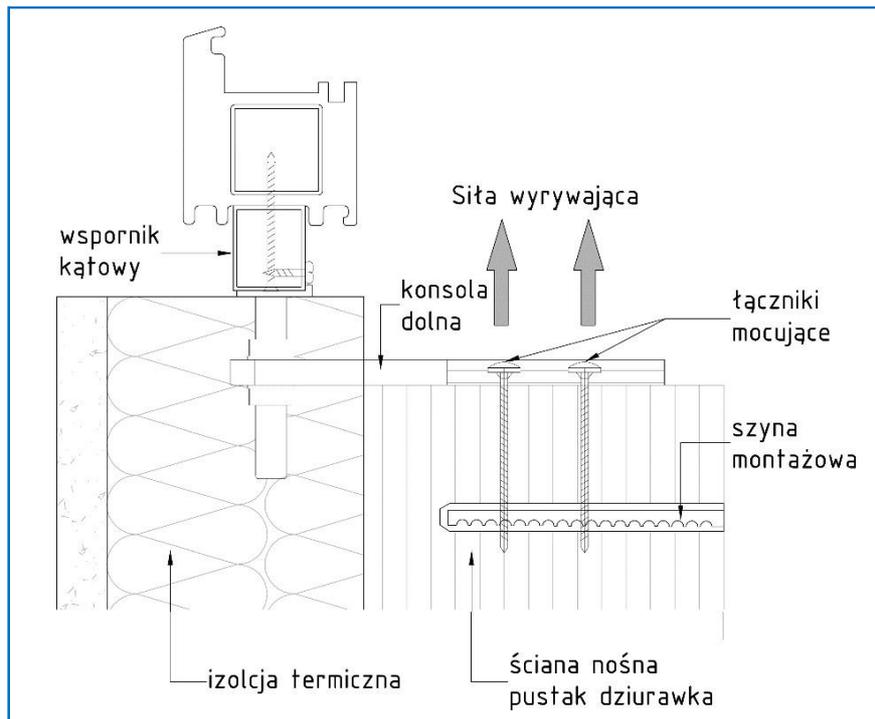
Esempio di montaggio della staffa inferiore al muro di tavelloni
